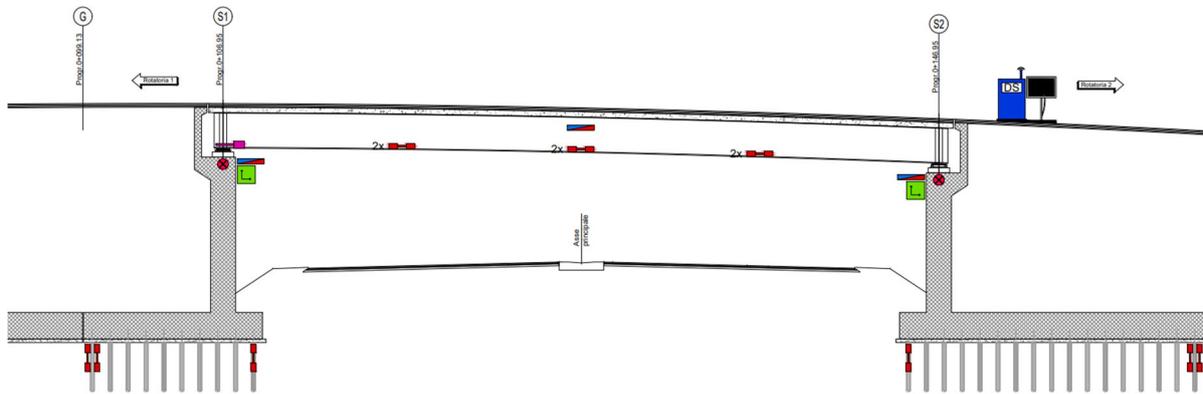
Ubicazione sensori su impalcato (Pianta GA01)
